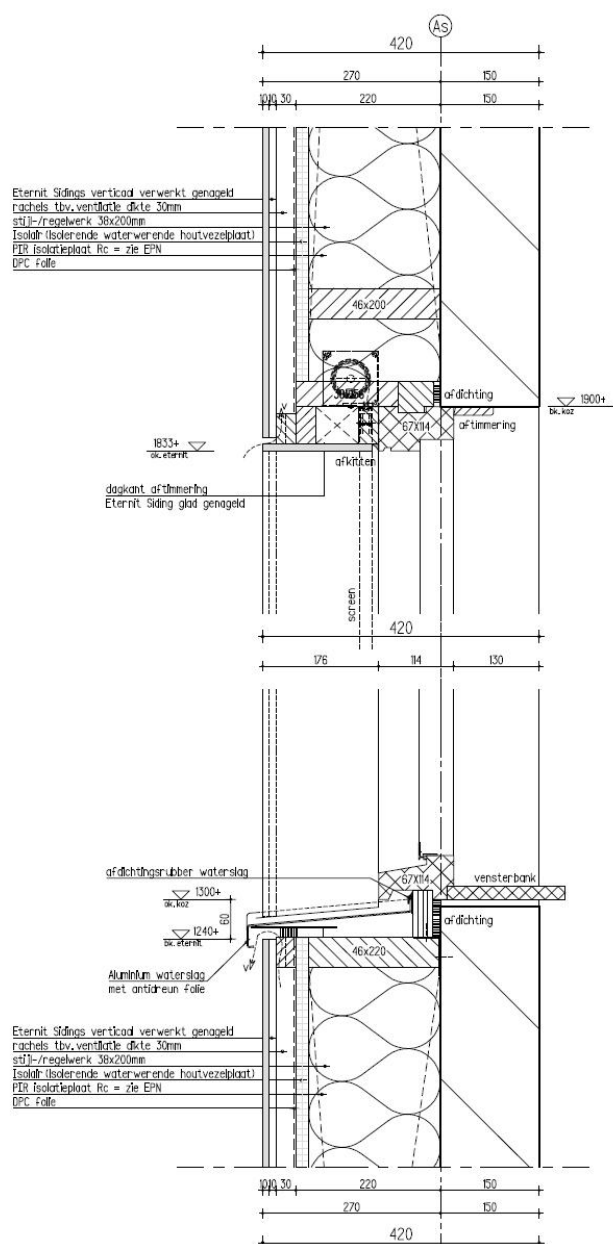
Horizontale snede raamaansluiting (detail 200)
